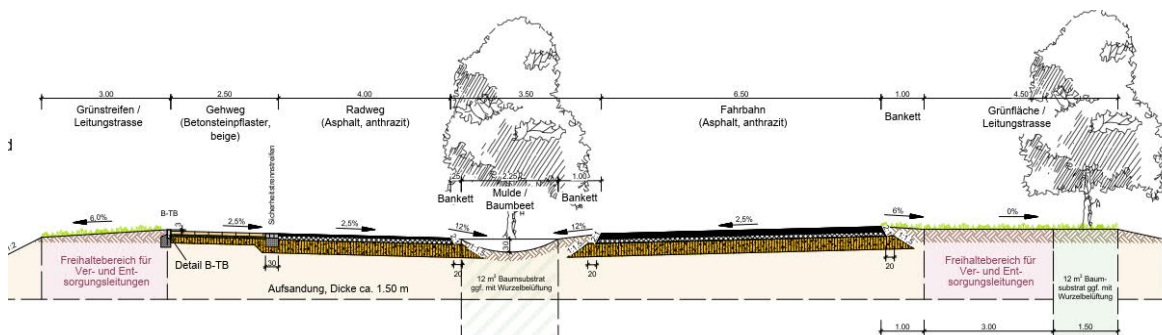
Regelquerschnitt Planstraßen A und B, Entwurfsplanung. Erläuterungsbericht. Teil E, Planung der Verkehrsanlagen, ARGE LuneDelta-suc, März 2023
